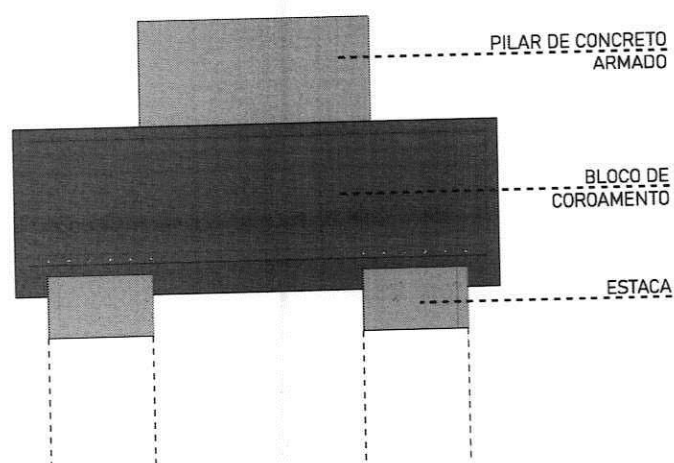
Bloco de coroamento e pilar de concreto armado presentes na fundação do tipo estaca
